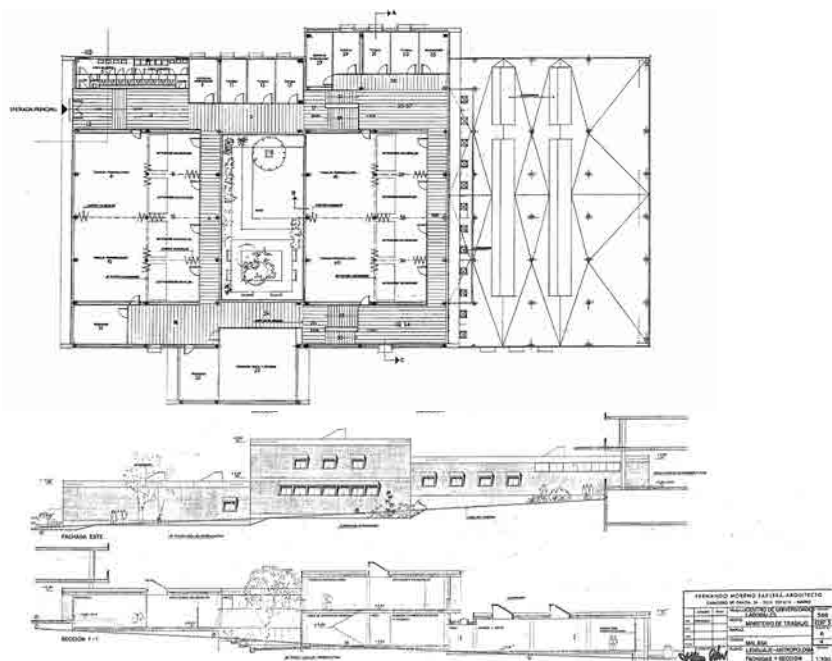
, Fig. 20 y Fig. 21 Aula de Lenguaje-Antropología. Planta superior (arriba), alzado de la fachada Este (centro) y sección longitudinal (abajo).
